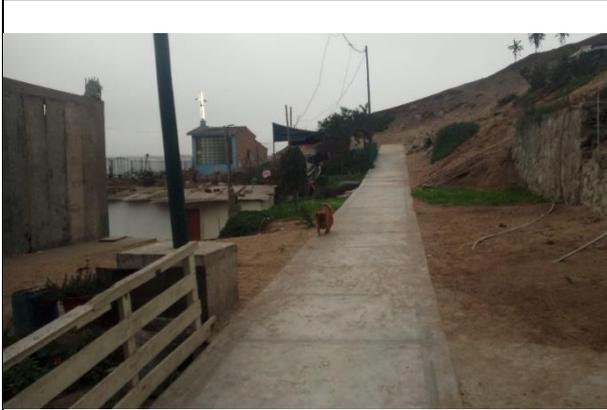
y N° 02: Vista de material constructivo de las veredas de concreto ciclópeo que sirve de conexión hacia las viviendas
